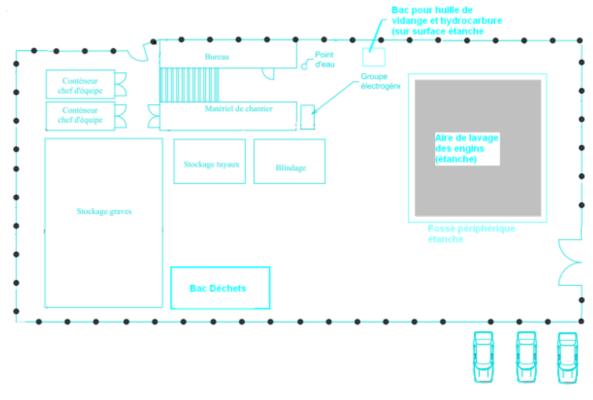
Plan d'installation de chantier type et principe de collecte des eaux pluviales de l'aire de lavage
